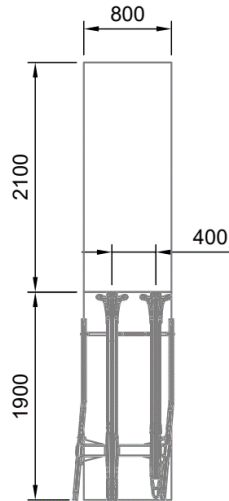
Acotación de la vista en planta de un módulo 2+2
